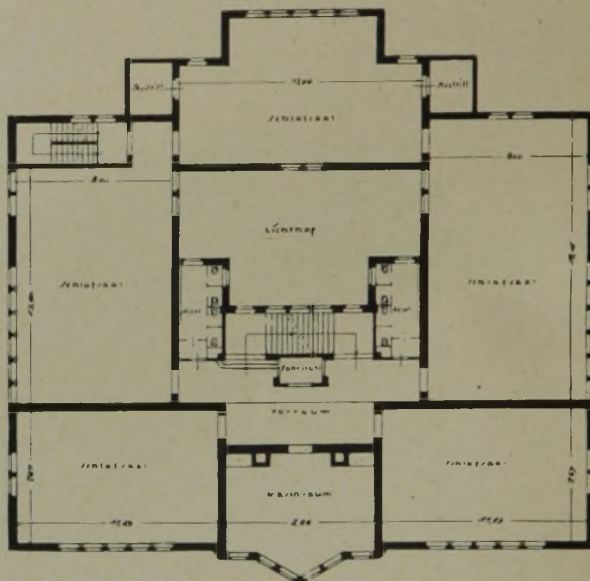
Grundriß des 2. u. 3. Obergeschosses.
